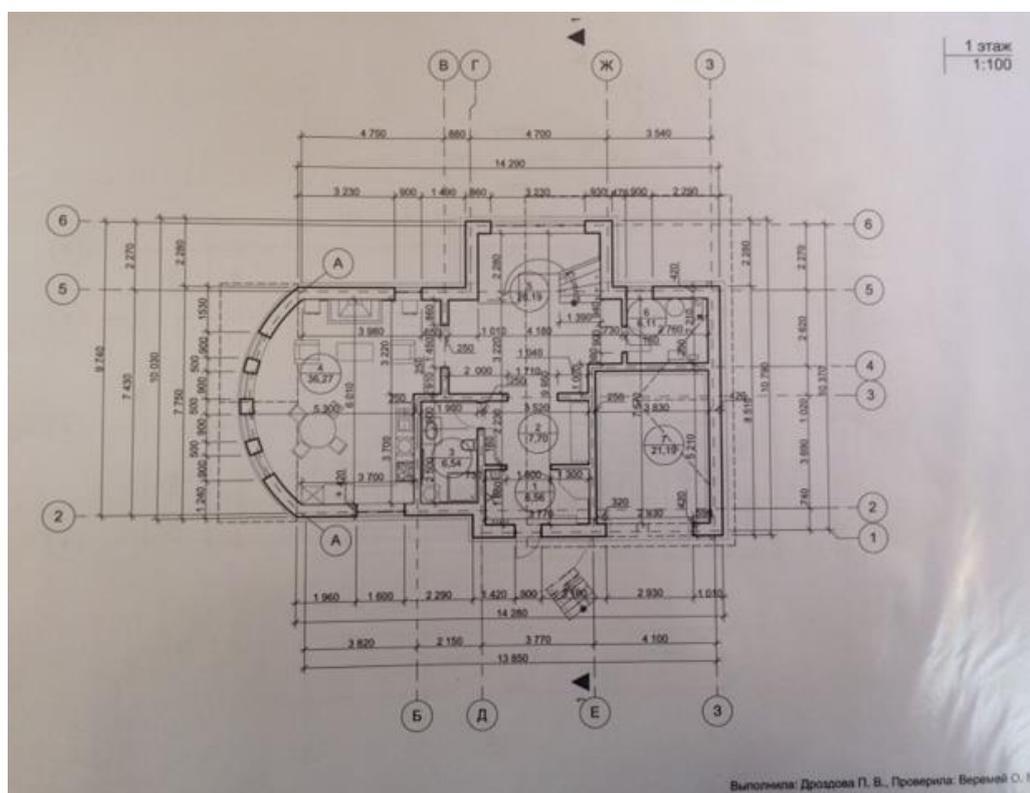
Работа 1. Один из выполненных планов здания (план первого этажа)
